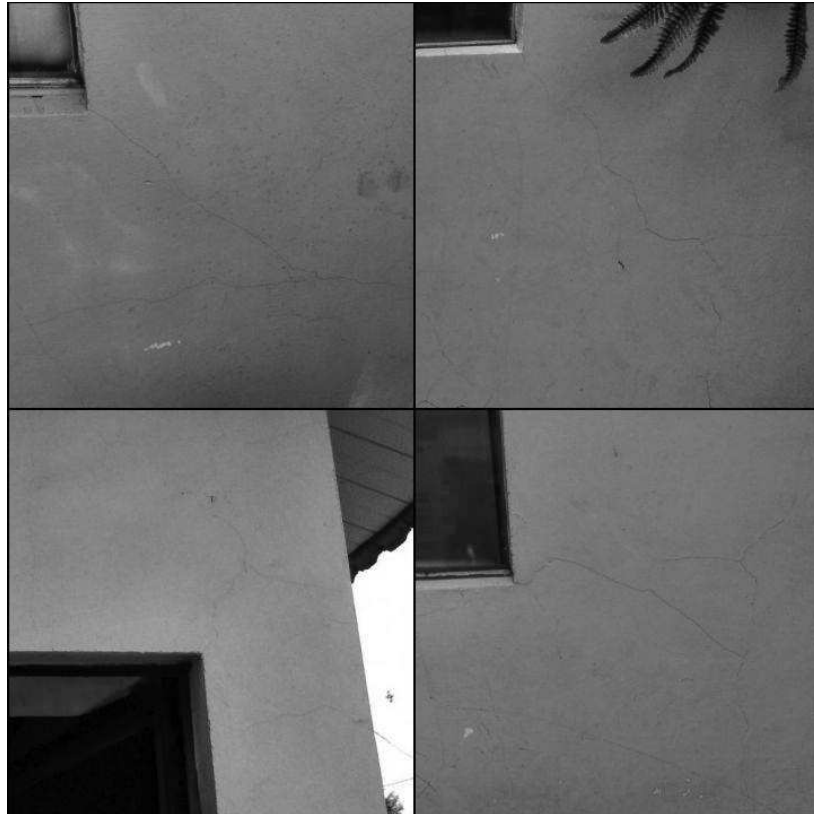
Fissuras inclinadas em cantos de janelas e portas
